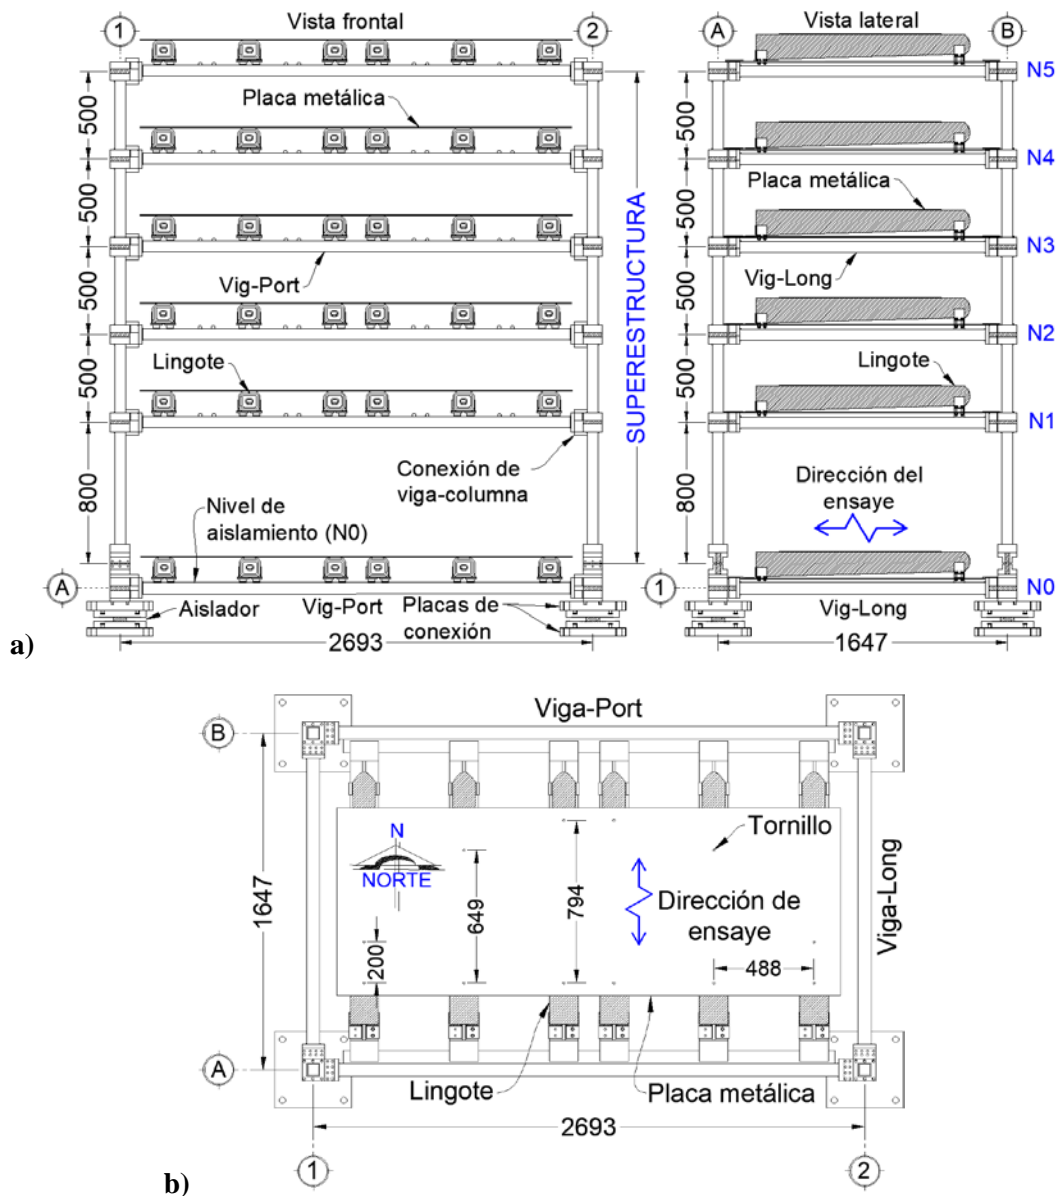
a) Vista frontal y lateral, b) Planta tipo de entrepiso (dimensiones en mm)
